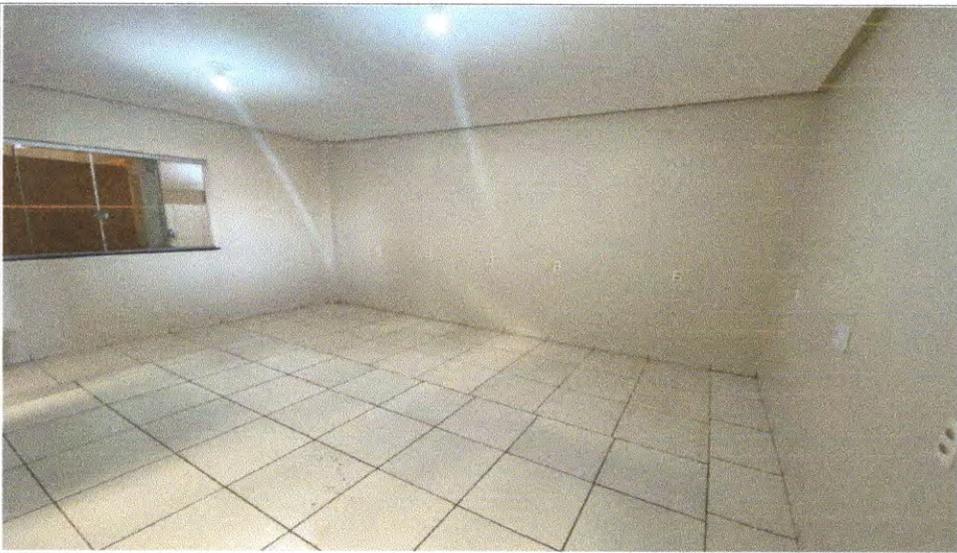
Sala 01 localizada no pavimento térreo do bloco 01.
